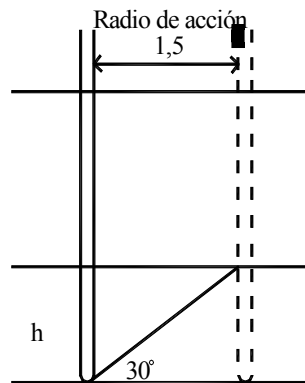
Introducción del vibrador en la capa inferior de hormigón
